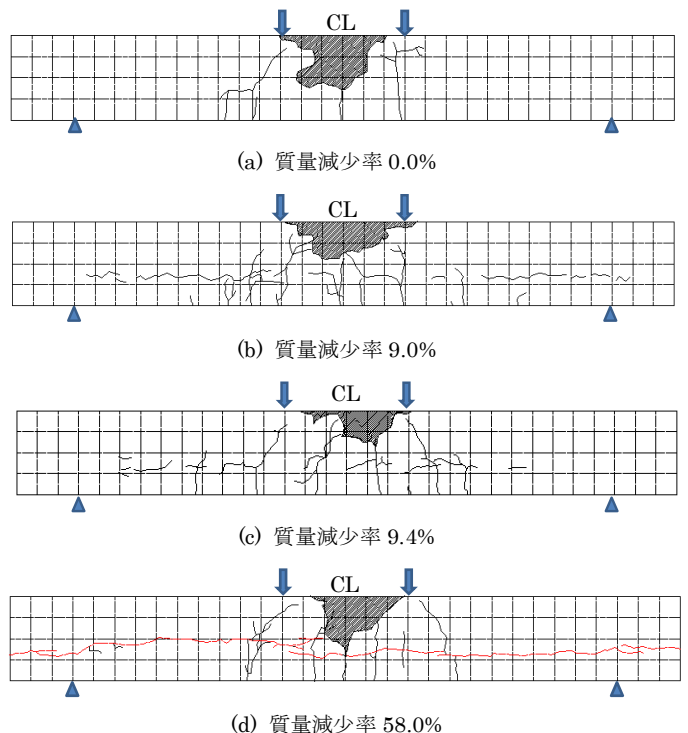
載荷試験後のひび割れ図 (赤線：腐食ひび割れ)
